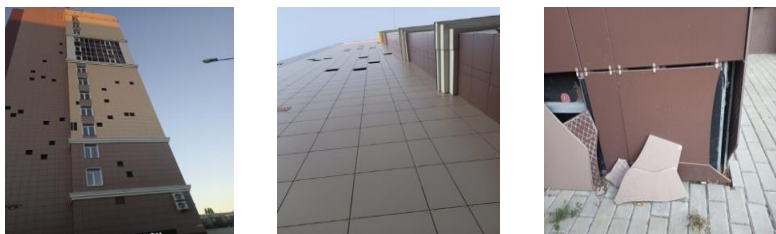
Нарушение целостности фасадных систем вентилируемого типа
